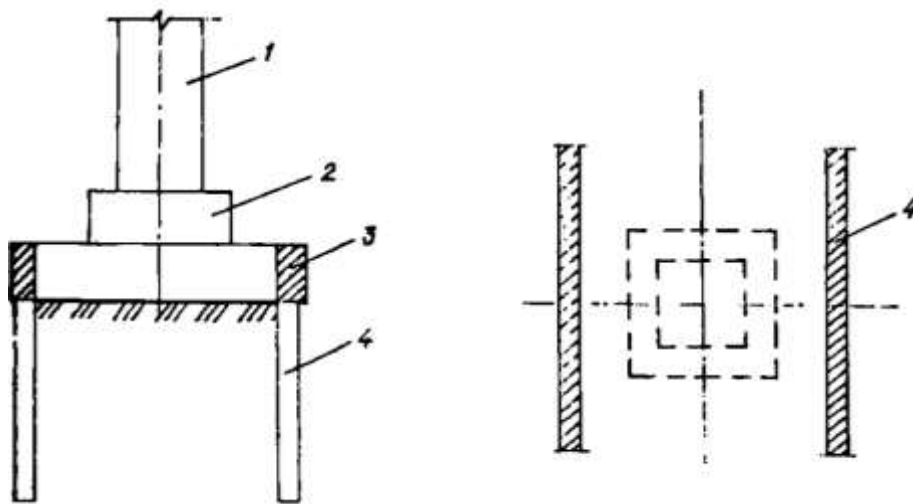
Підсилення стовпчастого фундаменту щілинними:
